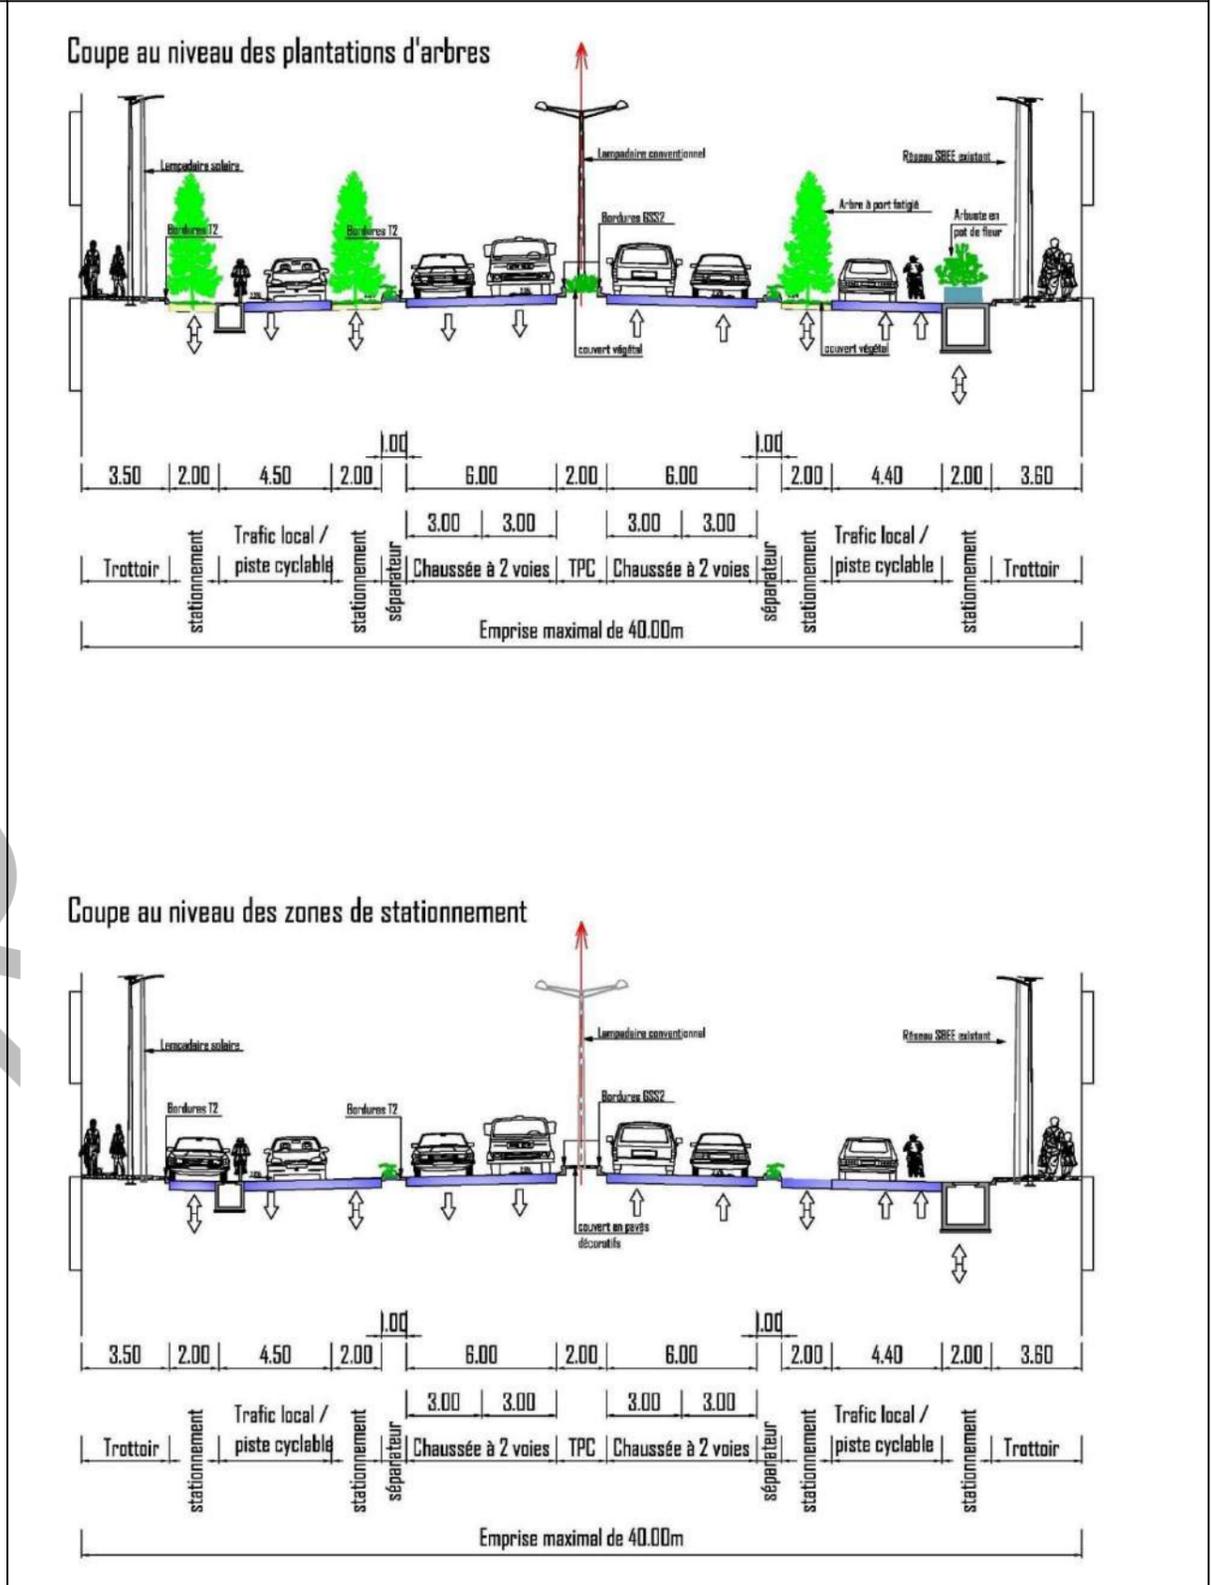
Profil en travers pour la section « carrefour Missèbo – carrefour Ciné VOG
